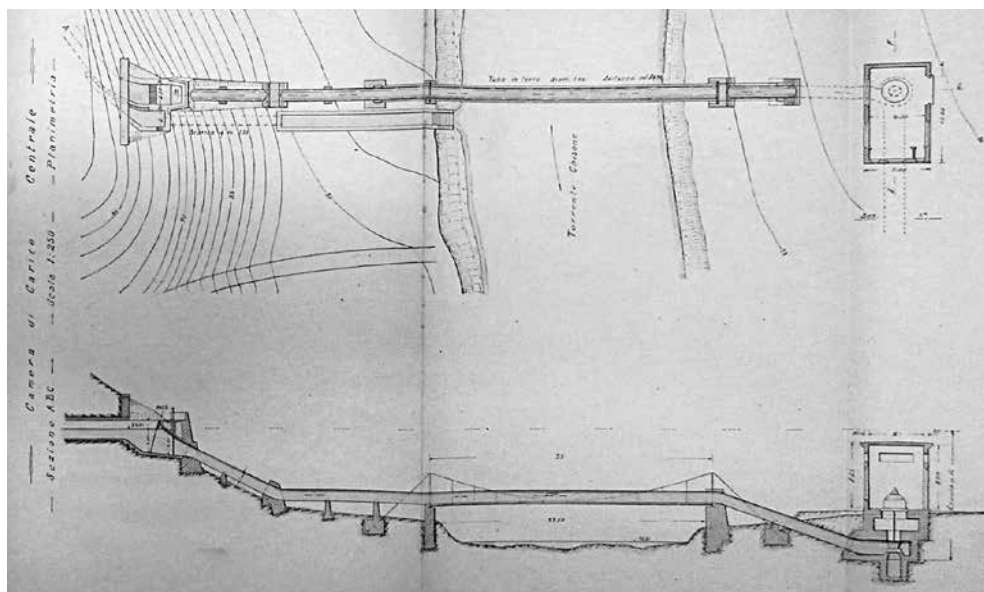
e 11. - Prospetto e sezione delle tubazioni in legno previsti per la condotta forzata del progetto del 15 gennaio 1927 (scala 1:25); pianta e sezione del superamento del Chisone per mezzo di un ponte in ferro della condotta alimentante la centrale, secondo l'ipotesi del 1942 (scala 1:250).
